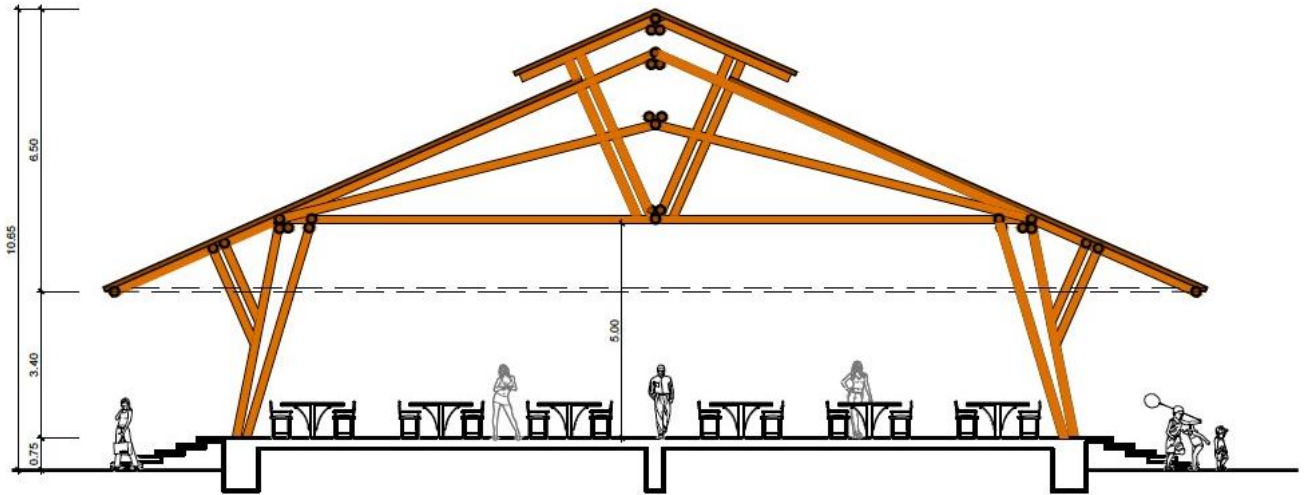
SECCIÓN TRANSVERSAL RESTAURANTE
